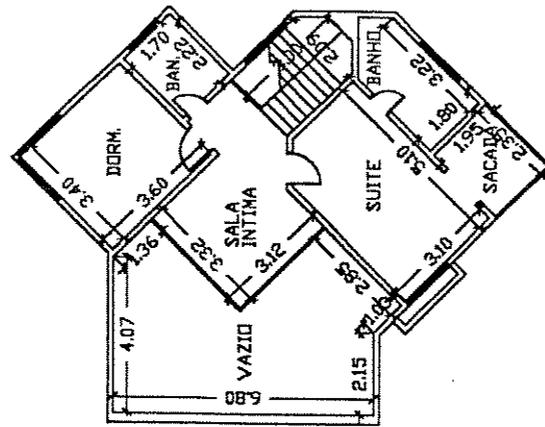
Planta baixa da Edificação 07. Fonte: Elaboração própria.
